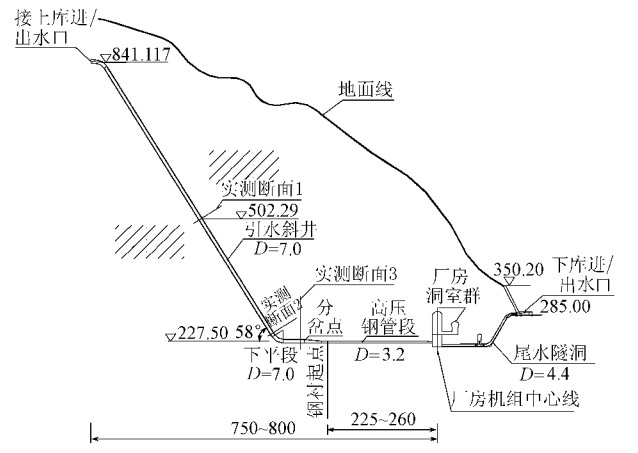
天荒坪工程输水道系统纵剖面布置(单位:m)及调相等重要作用,鉴于工程的重要性和设计、运行需要,在整个工程中布置了许多观测仪器,收集实测数据,以供决策和分析探讨时用,其中在输水道系统中的钢筋混凝土高压隧洞 1 号斜井布置了 3 个观测断面(图 1),每个断面都布置有渗压计、测缝计和钢筋计,分别观测衬砌外层压力、衬砌与围岩的缝隙以及衬砌钢筋应力。3 个观测断面的特性参数见表 1。
